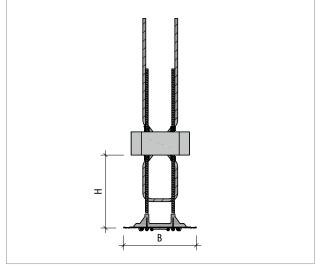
Schöck Sconnex® type W : coupe du produit avec aide au montage
